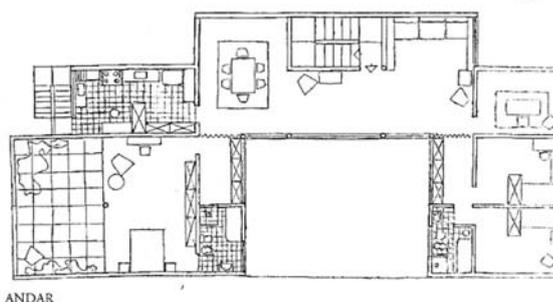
Lucio Costa, Casa sem Dono 02, 1934-36, Planta Baixa. Fonte: Costa 1995, 86.
